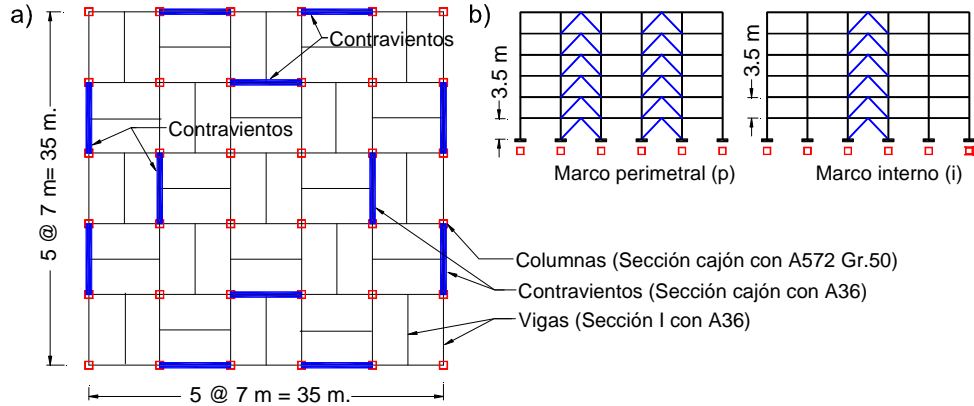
a) Planta tipo, b) Elevación tipo de los marcos estudiados
